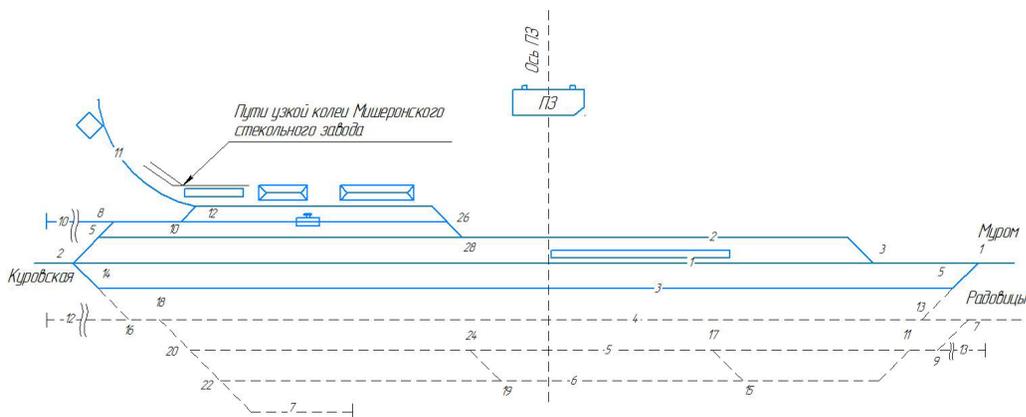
Схематический план станции Кривандино. Реконструкция на основе ГБУ «ЦГА Москвы»
